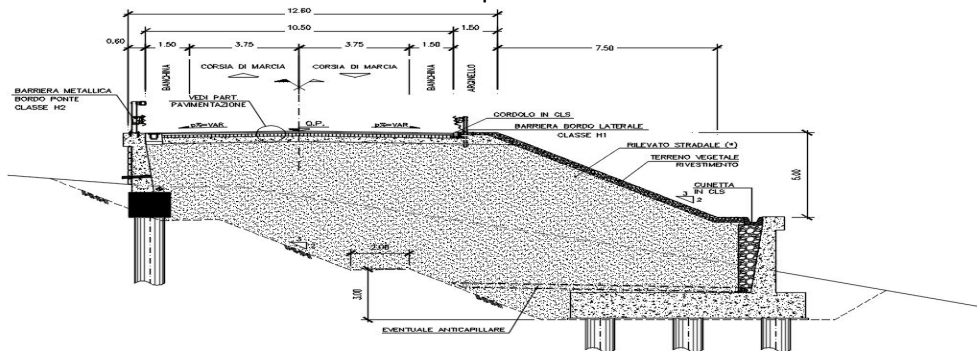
Sezione tipo in rilevato asse principale fra muri
